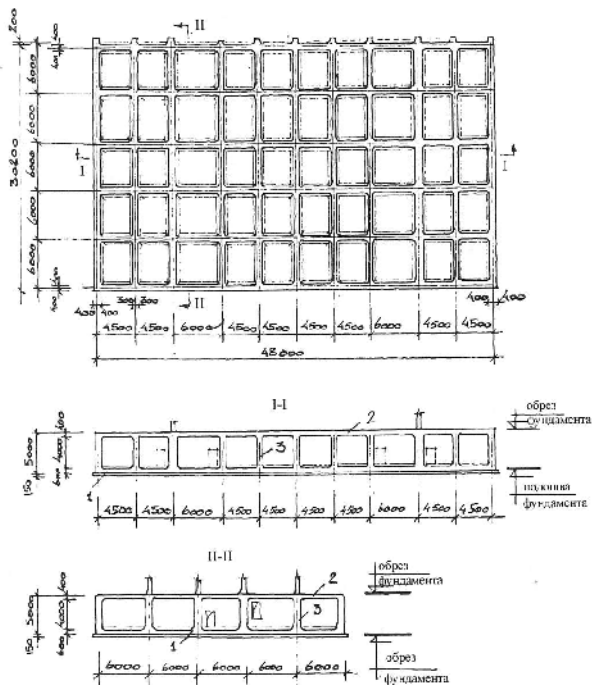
Пример решения фундамента в виде железобетонных замкнутых коробок: 1 – нижняя плита; 2 – верхняя плита; 3 – поперечные стенки фундамента
